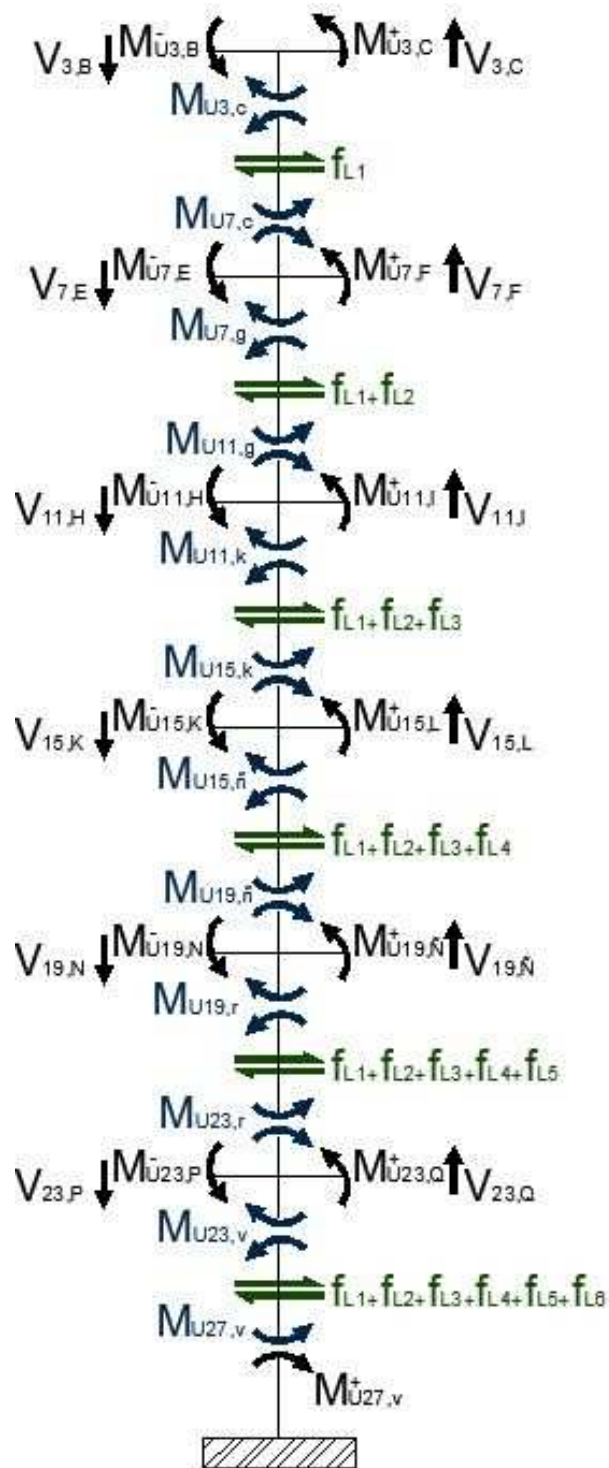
Planteamiento de equilibrio de nudos. Pilar 3. Pórtico 1
